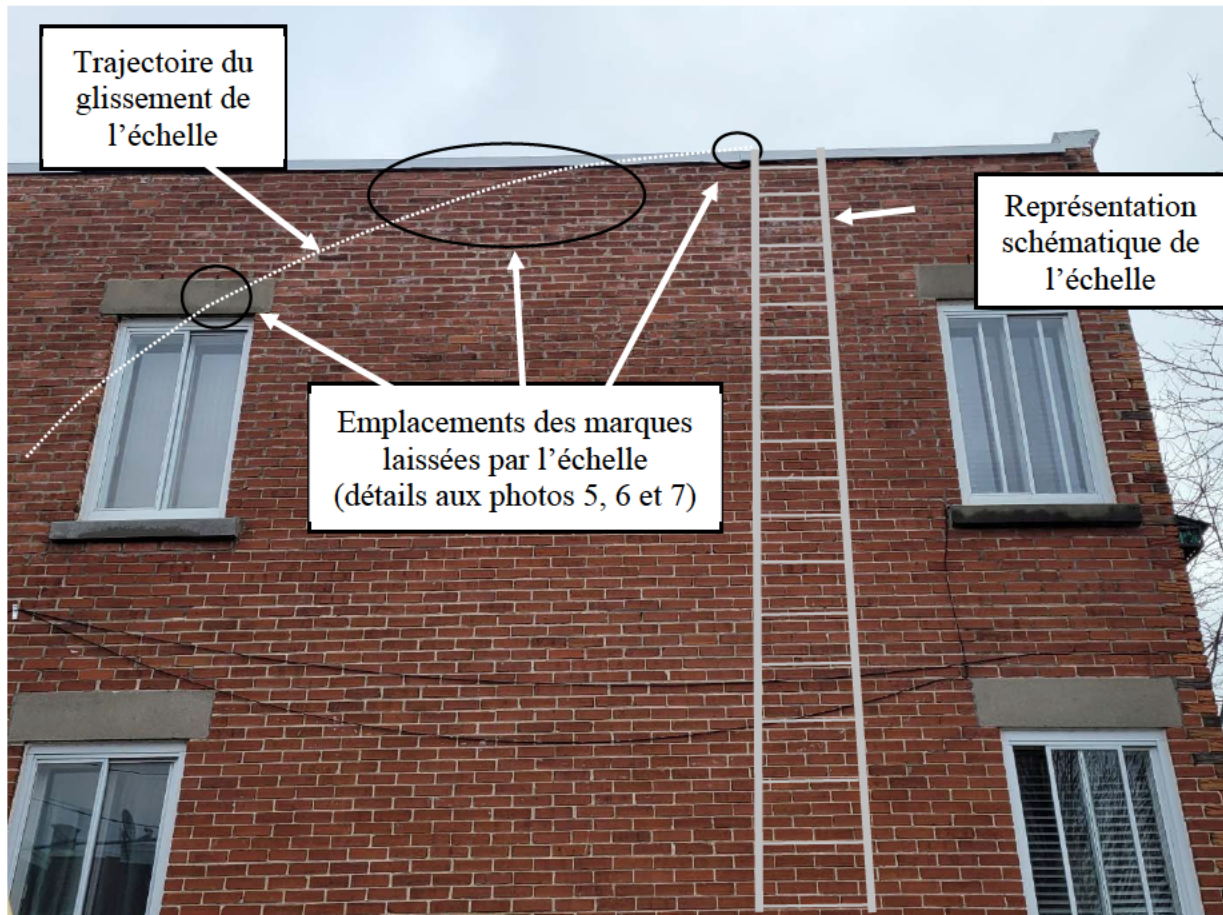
Marques laissées par l'échelle lors de son glissement sur le mur ouest (Source et modifiée : CNESST)
